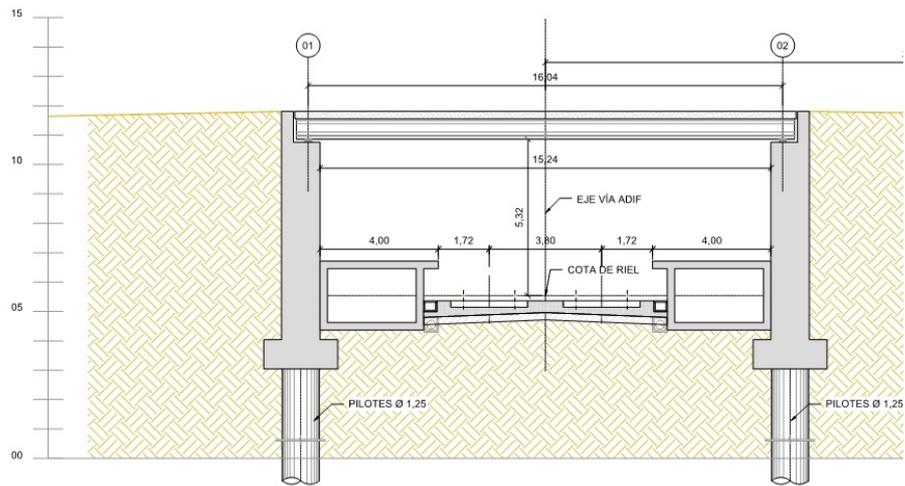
Sección transversal del Tramo 2. Cobertura andenes ADIF
